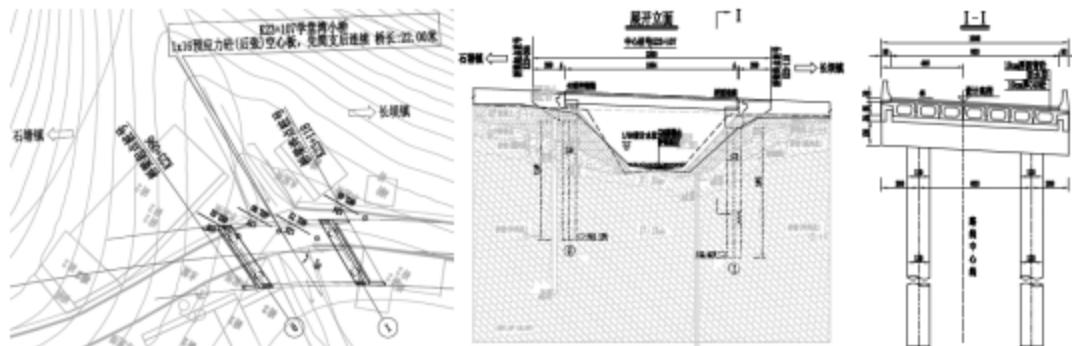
K23+107学堂湾小桥桥位、桥型平面布置图
